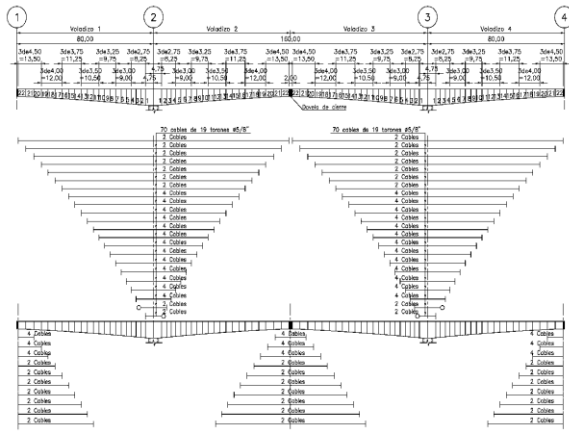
Vista longitudinal de la viga del puente y distribución de los cables de presfuerzo. Fuente: Autores.
